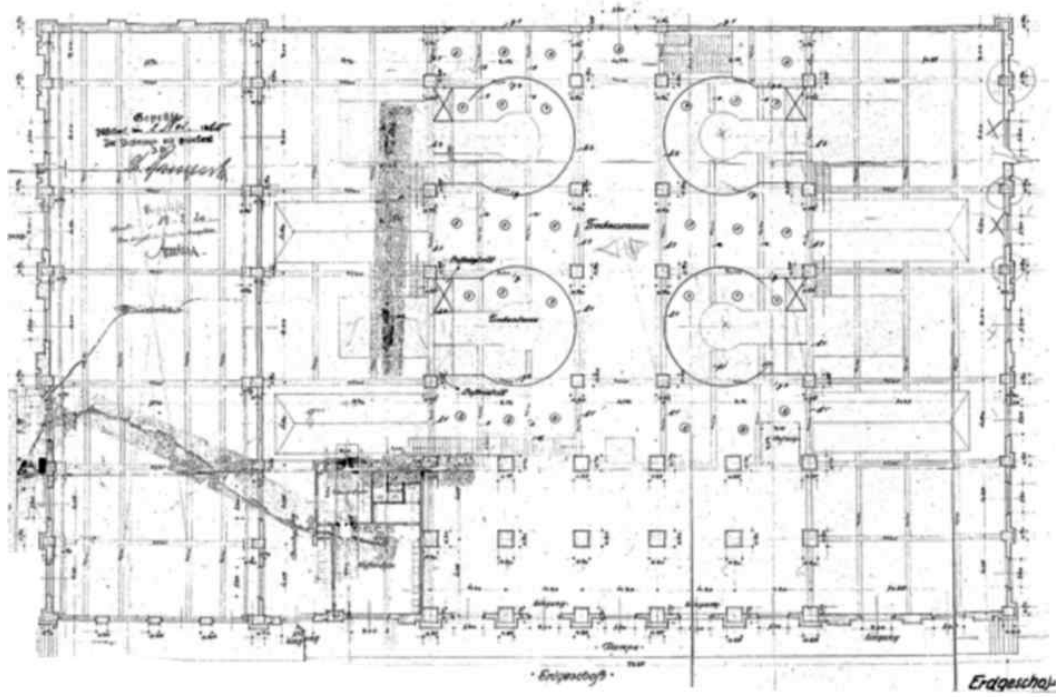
Erdgeschossgrundriss Geb. E 07, 1919/20 - Architekt: Walter Furthmann
